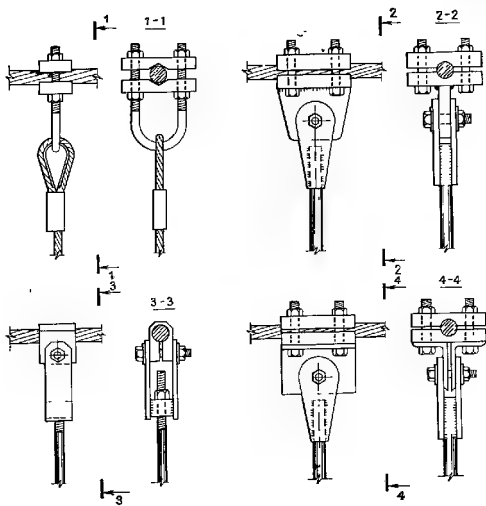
Варианты крепления растяжек к поясам вантовых ферм
